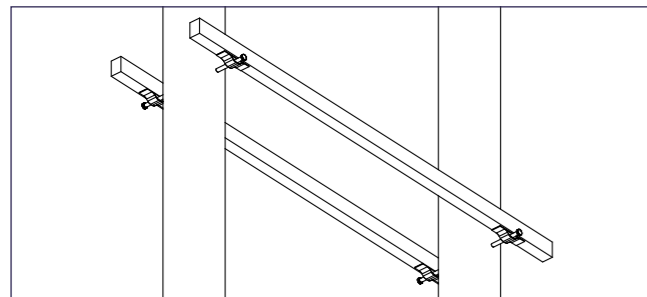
Типовая схема крепления балок с опорой на два ствола
